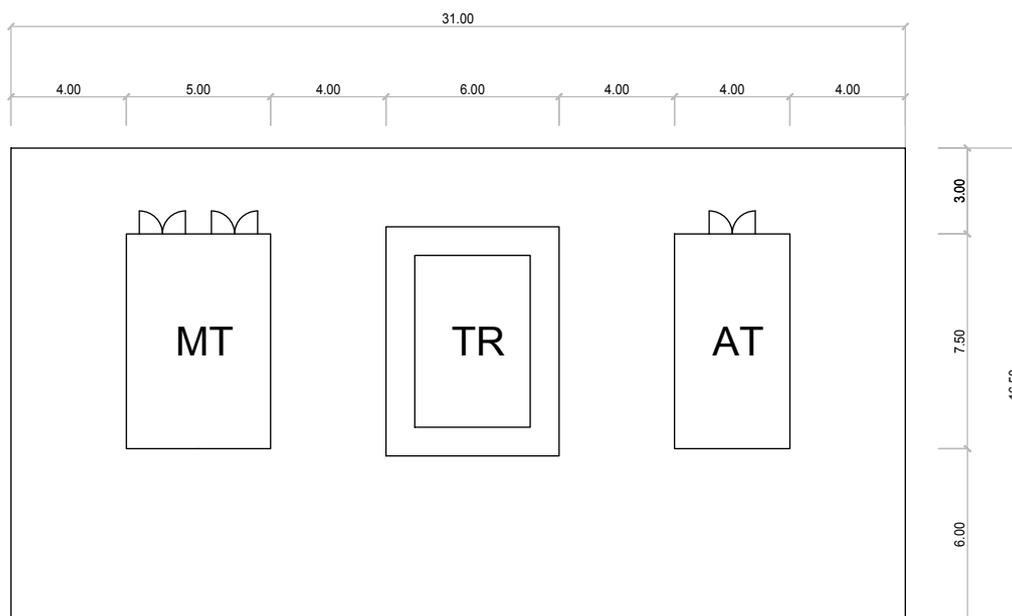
Platea di fondazione dell'area di trasformazione e disposizione cabine
